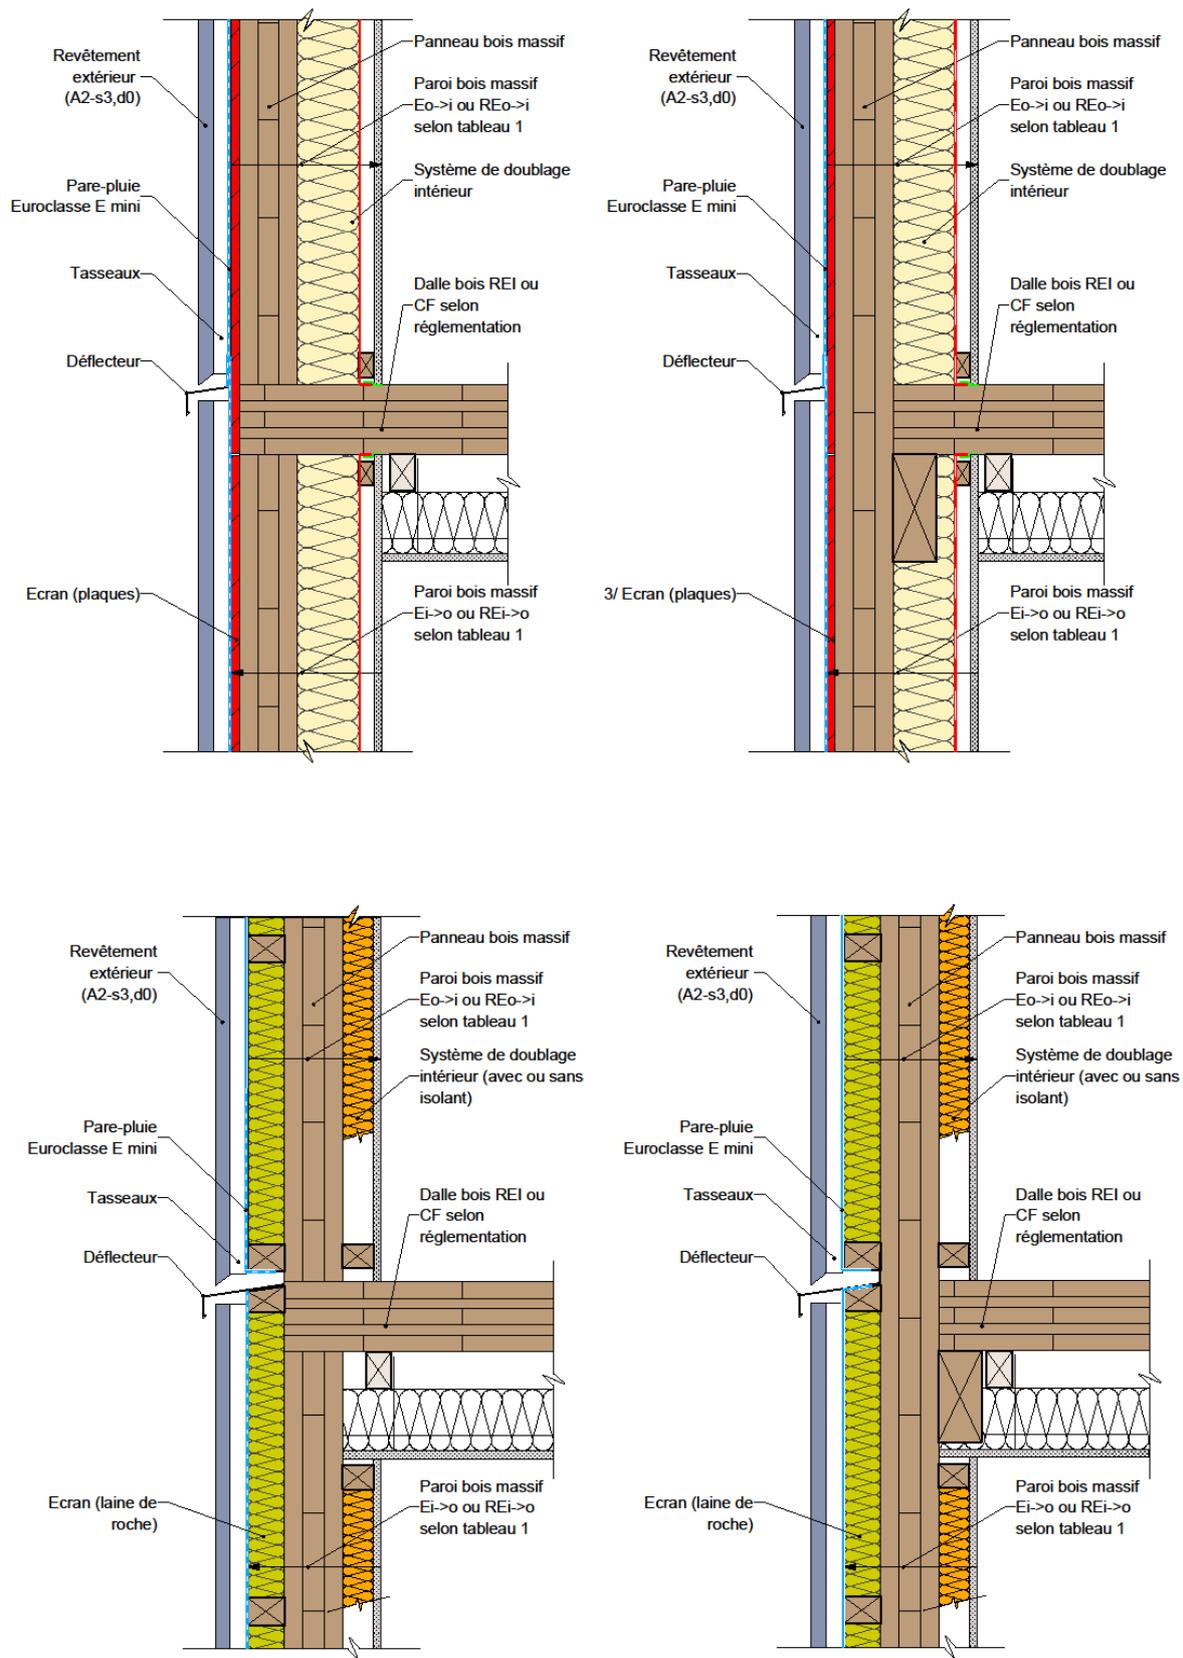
Façade/mur en panneaux bois massif & plancher en panneaux bois massif.
